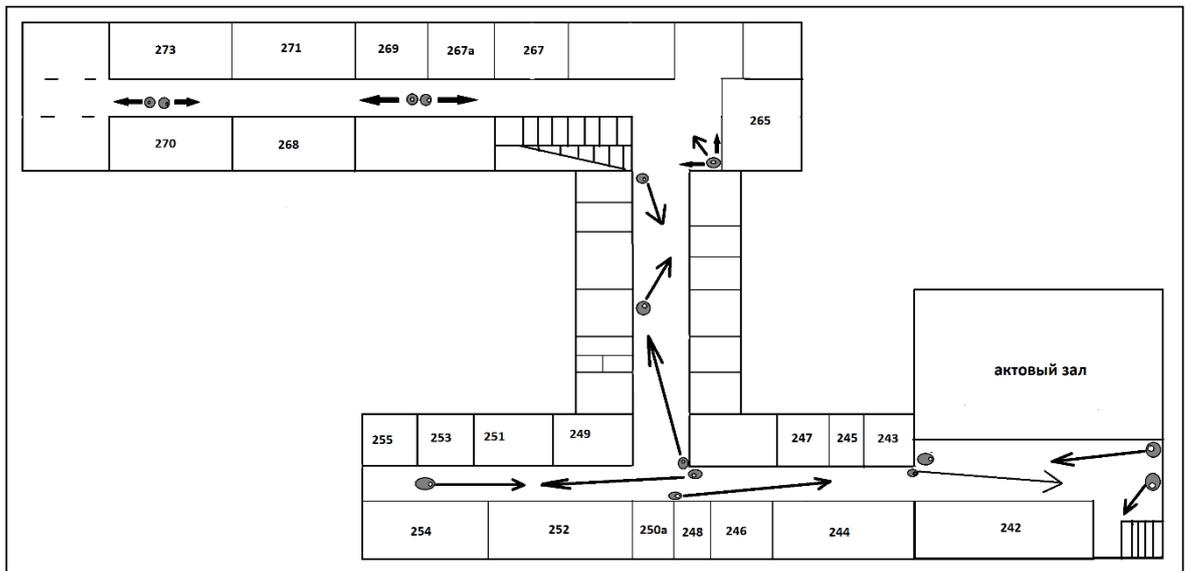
Спроектированный план здания ГМК КазНТУ – 2 этаж
